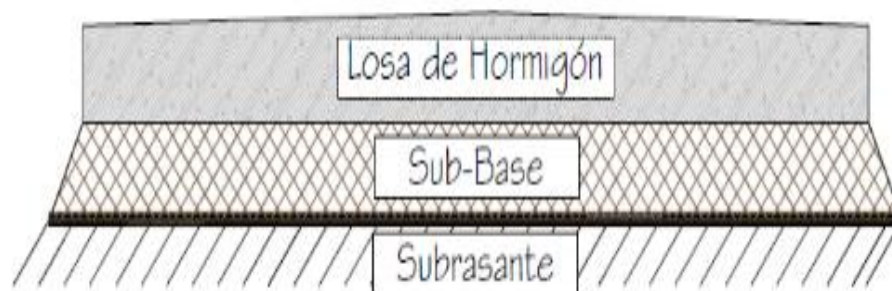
Tipos de pavimentos flexibles y rígidos, sección típica transversal pavimento rígido
